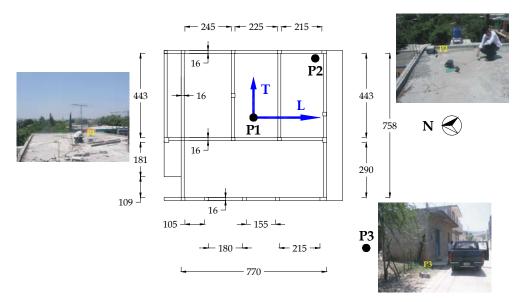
Croquis en planta (dimensiones en centímetros) de la azotea de la vivienda 2 y ubicación de los puntos de registro de vibración ambiental.
